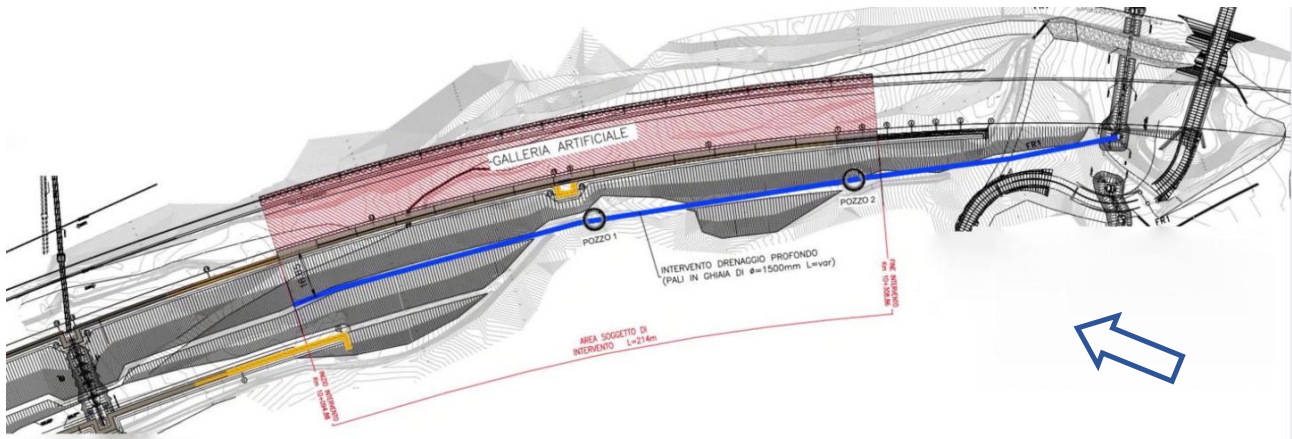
Planimetria delle nuove opere di progetto nell' area intervento. In rosso l'impronta della galleria artificiale; in blu l'asse di drenaggio di monte, con i due pozzi interferenti
